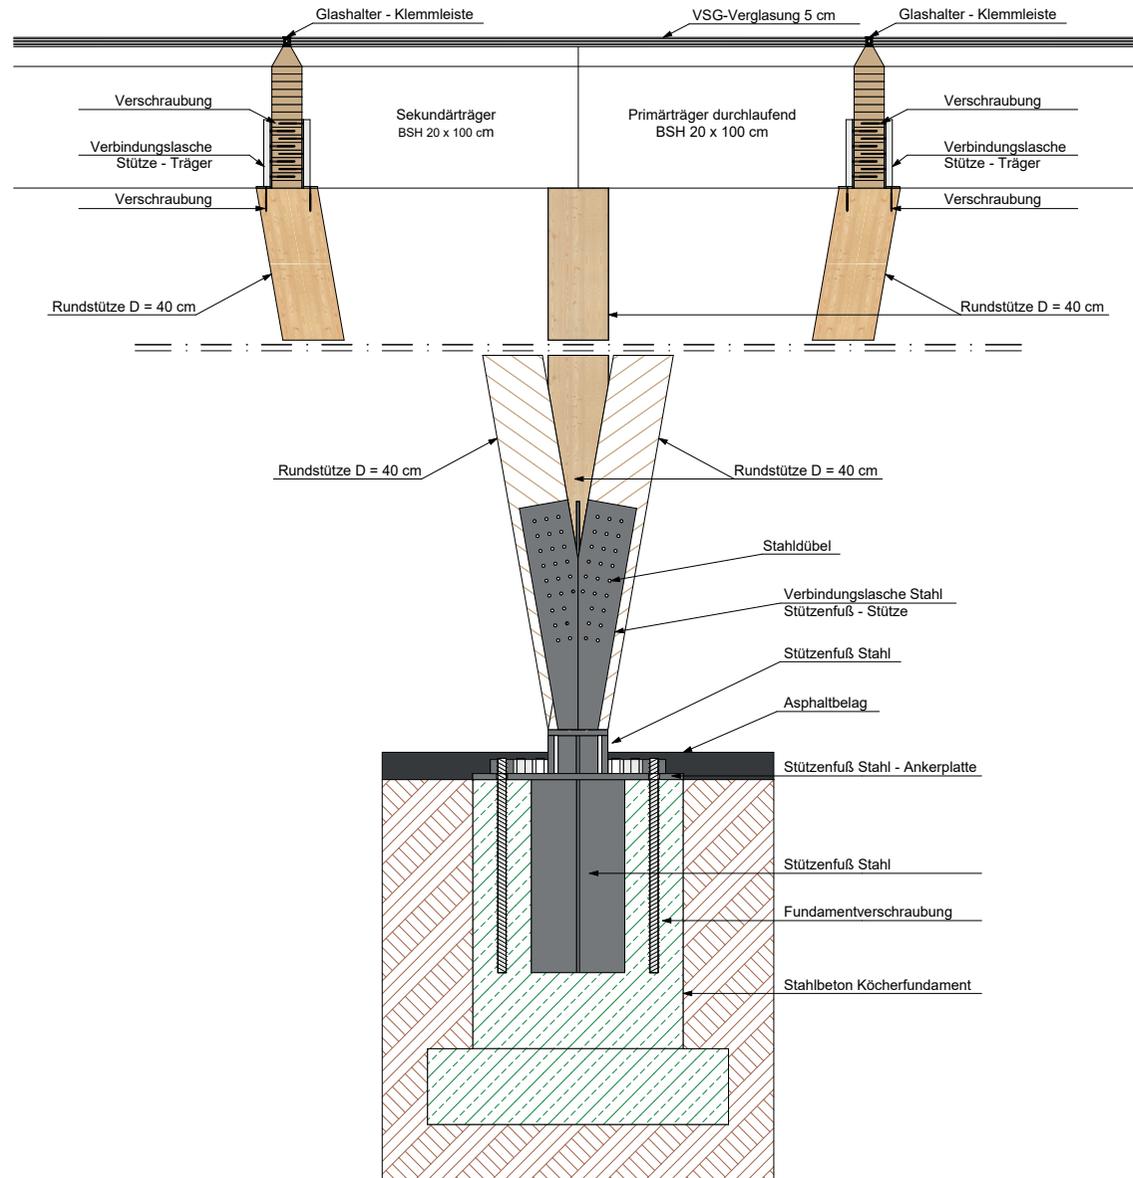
Detail Stütze und Auflager Dachkonstruktion
